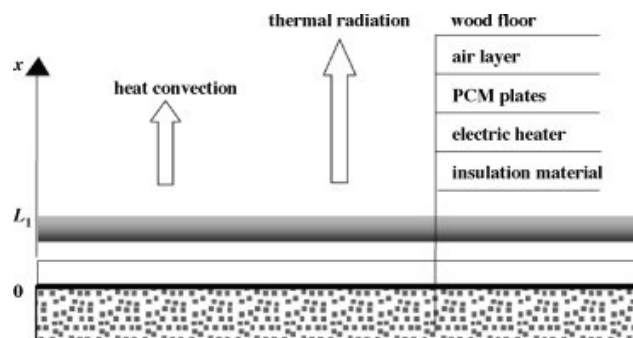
Schema di sistema di riscaldamento elettrico a pavimento con piastre PCM a forma stabilizzata. [37]
